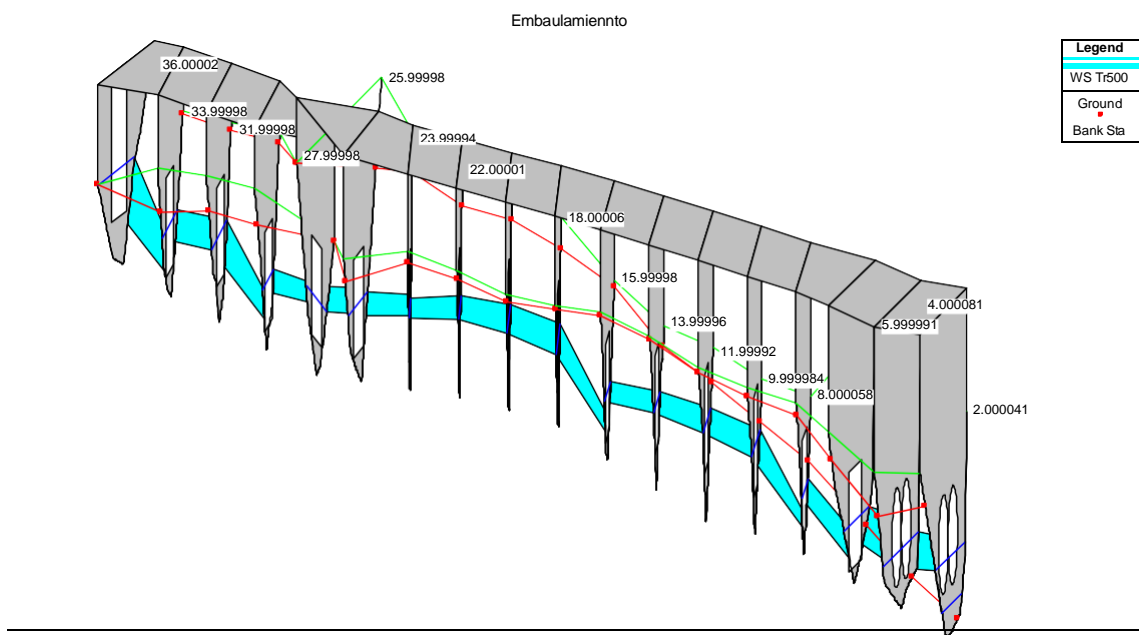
Vista tridimensional de la estructura del embaulamiento vista de perfil.
